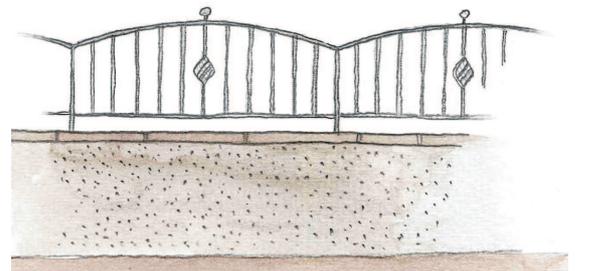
RECINZIONE IN ACCIAIO SU STRUTTURA MURARIA
